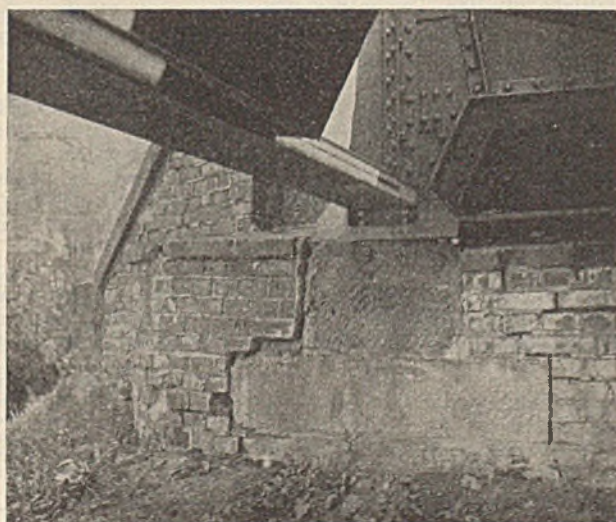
Lagerung des Hauptträgers und zerstörtes Widerlager.
